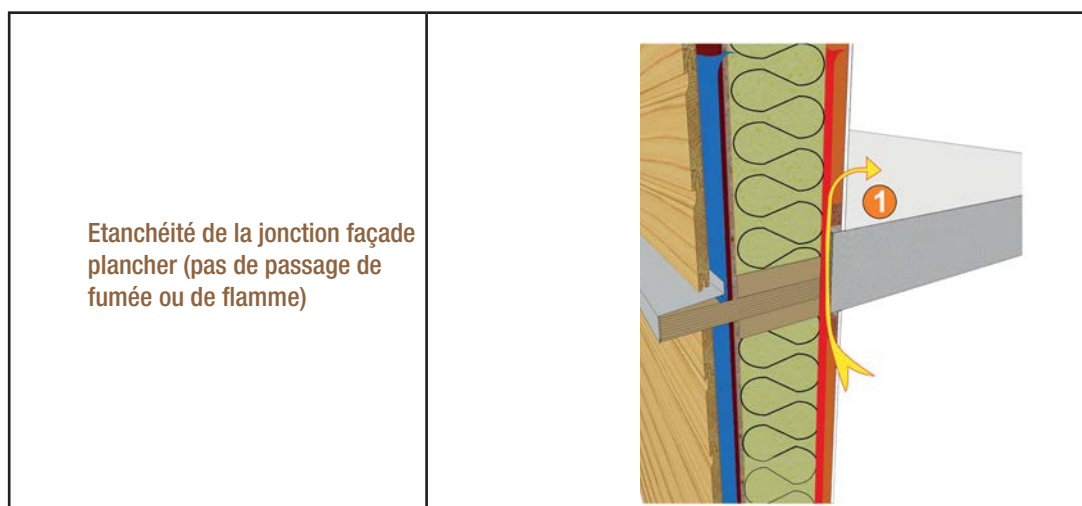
Représentation de l'exigence étanchéité de dalle et paroi de la façade
